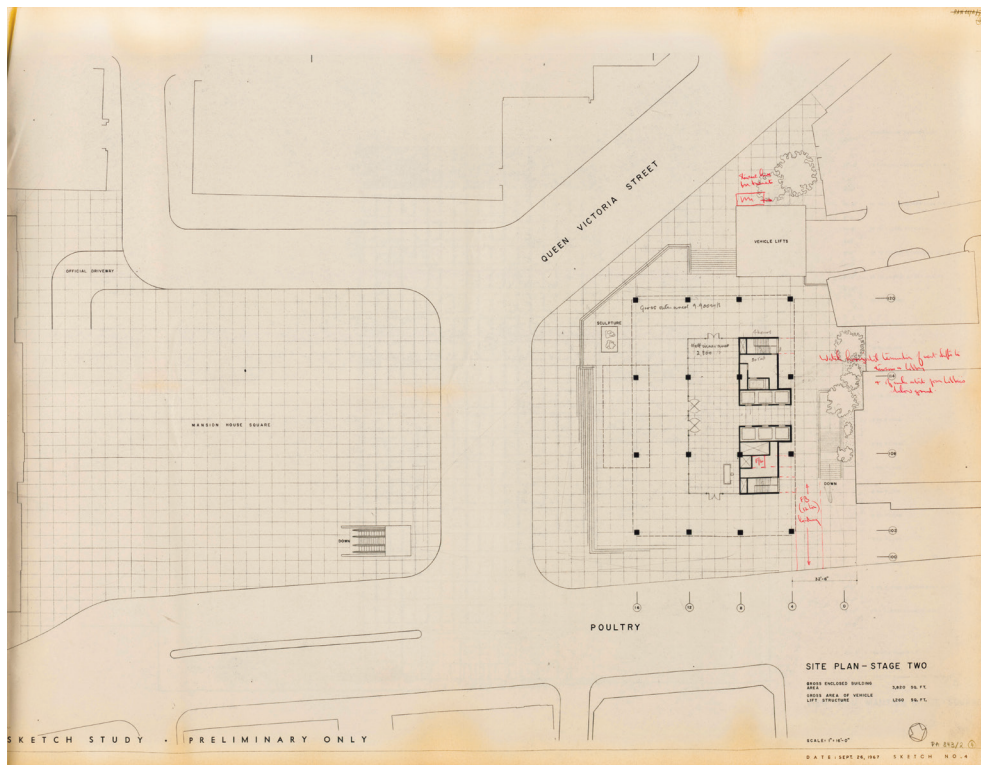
Proposta de praça menor com a rua *Queen Victoria* chegando até a rua *Poultry* (set. 1967, Site Plan — Stage 2).
